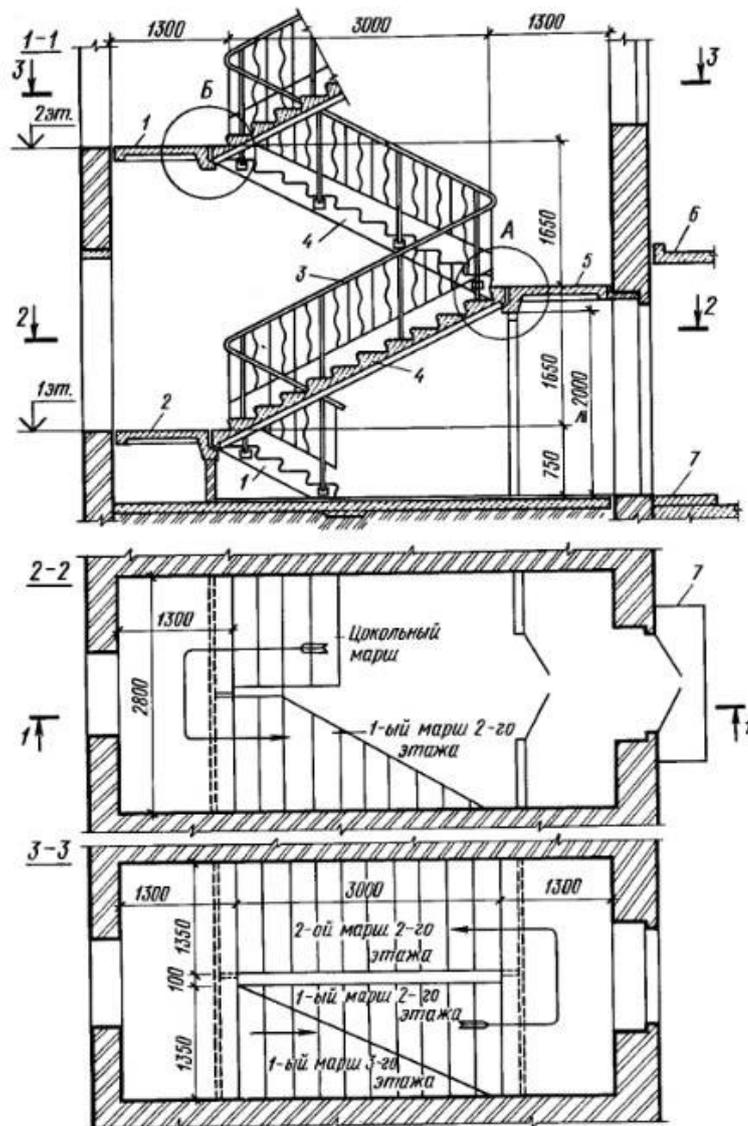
Двухмаршевая лестница (разрез и поэтажные планы): 1 - цокольный марш, 2 - этажные площадки, 3 – ограждение, 4 – лестничный марш, 5 - междуэтажная площадка, 6 – входной козырёк, 7 - входная площадка.
